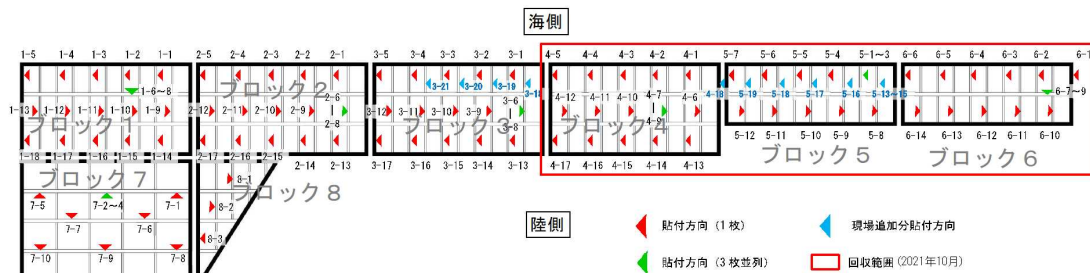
薄板モルタル供試体の設置図（平面位置図）と第1回収範囲（赤枠）
